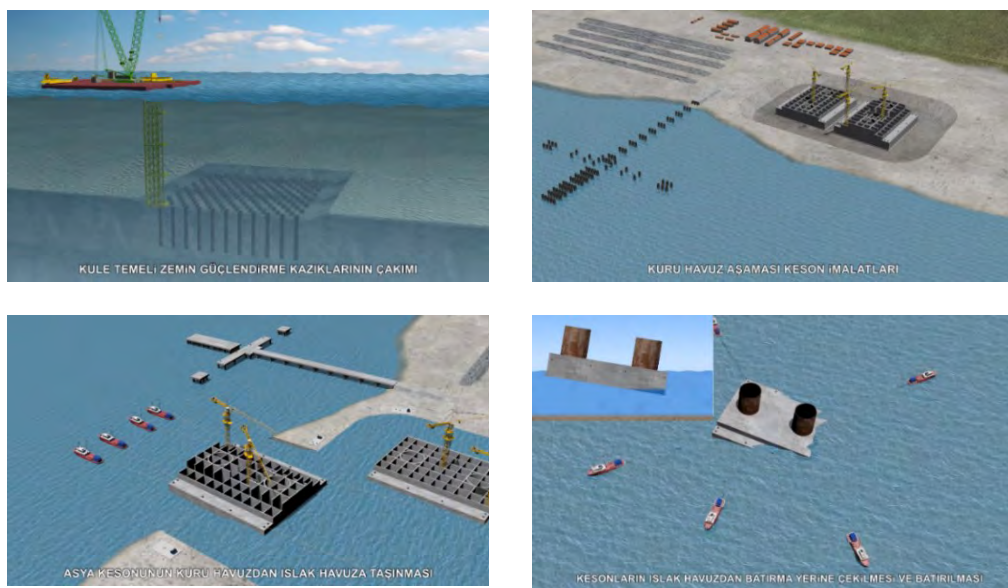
Fasi di realizzazione delle fondazioni del «1915 Çanakkale Bridge<sup>162</sup>»
